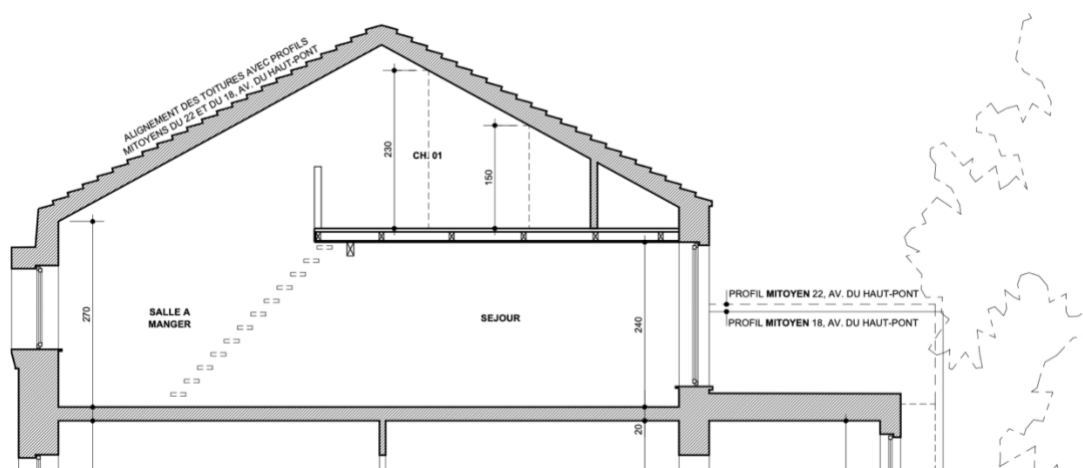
Coupe dans la mezzanine du dernier étage.
